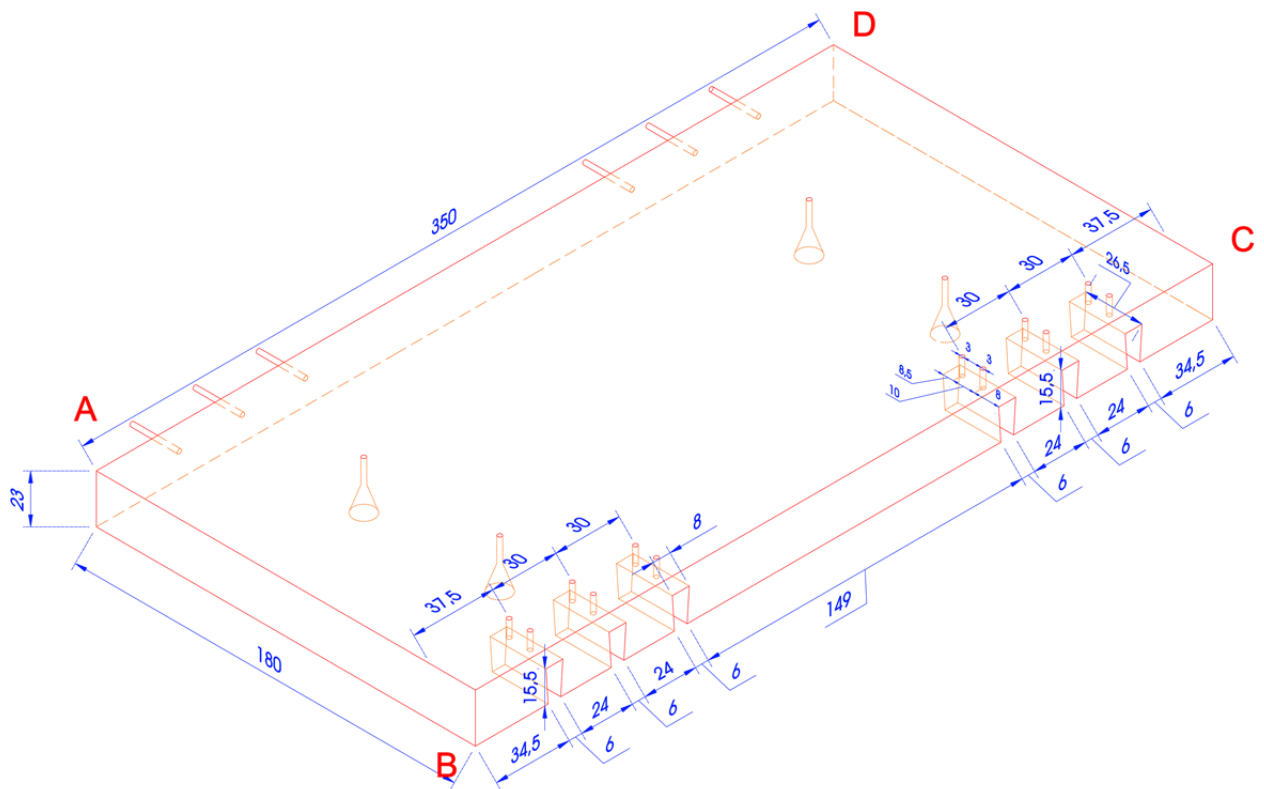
Panel ranuras – barras vista cara B-C con detalle de ranuras.
